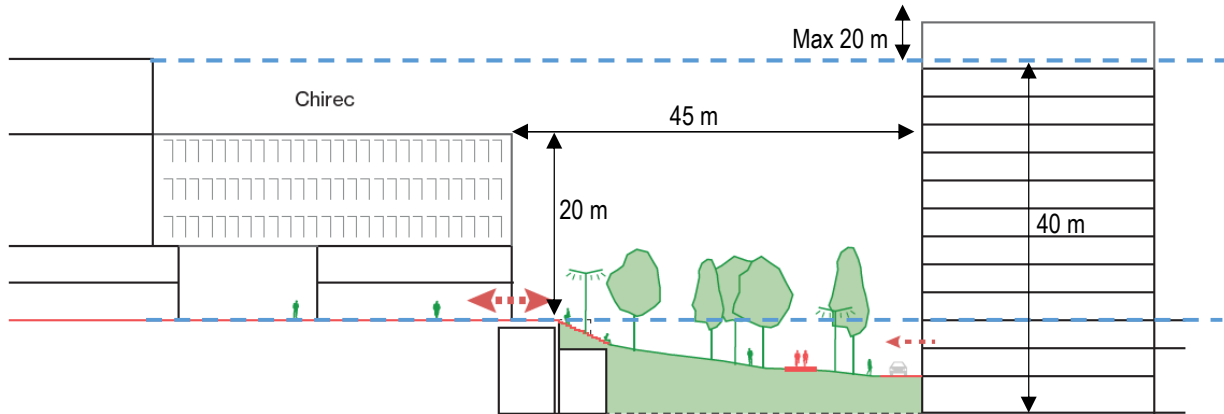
Profil du parkway du site Triangle (ARIES sur fond ORG², 2018)
